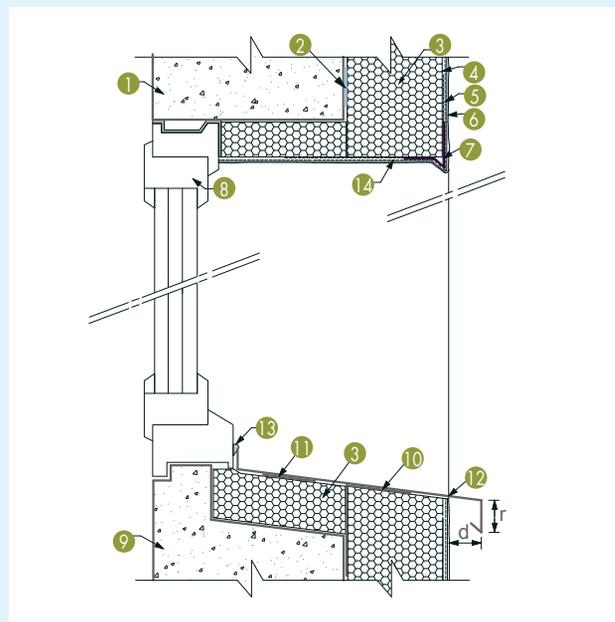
Coupe sur baies en service - appui maçonné trop court (coupe verticale)
